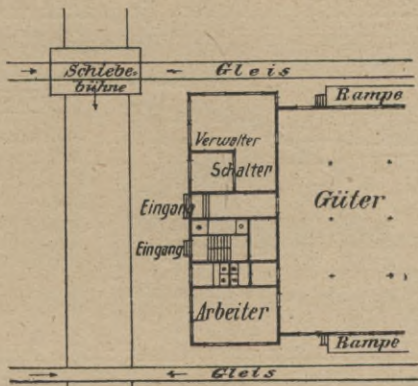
Mehrgeschossiger Bauteil einer großen Güterhalle.
